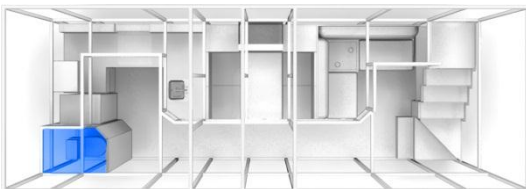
Planta inferior del Habita-Mueble (Medio baño).
